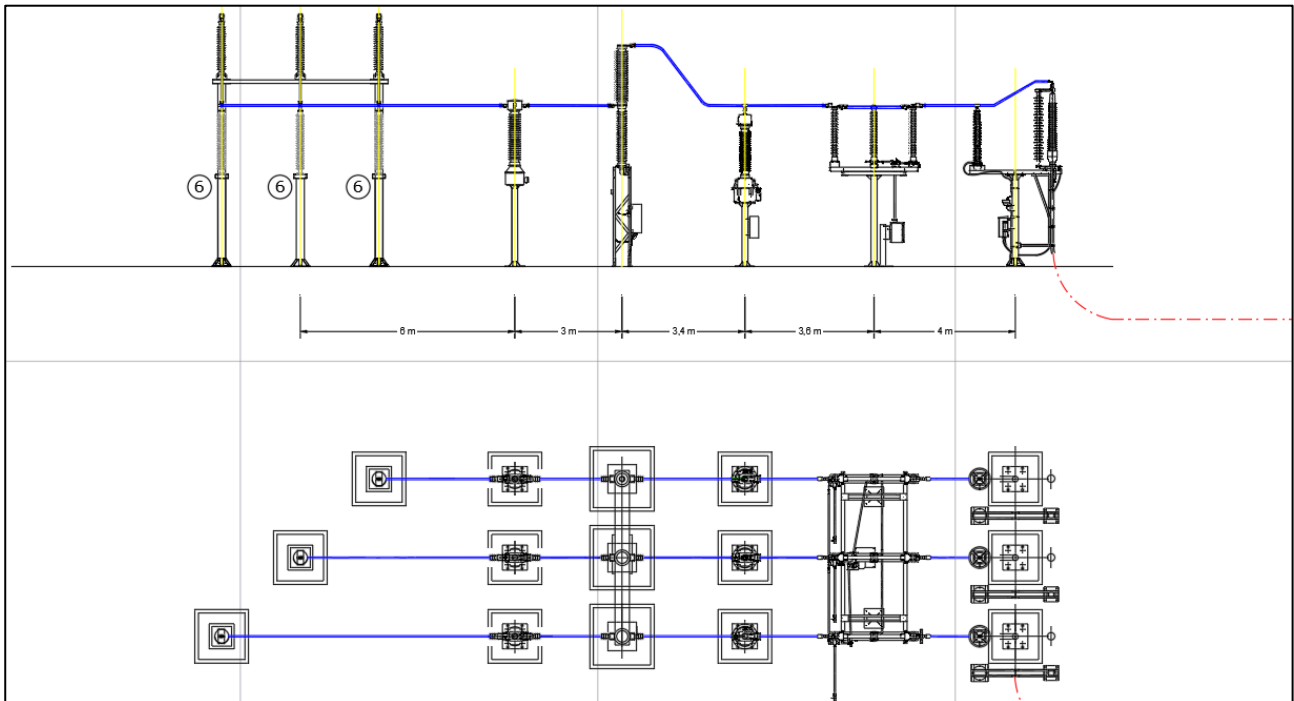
Vista in pianta e vista laterale stallo partenza linea
